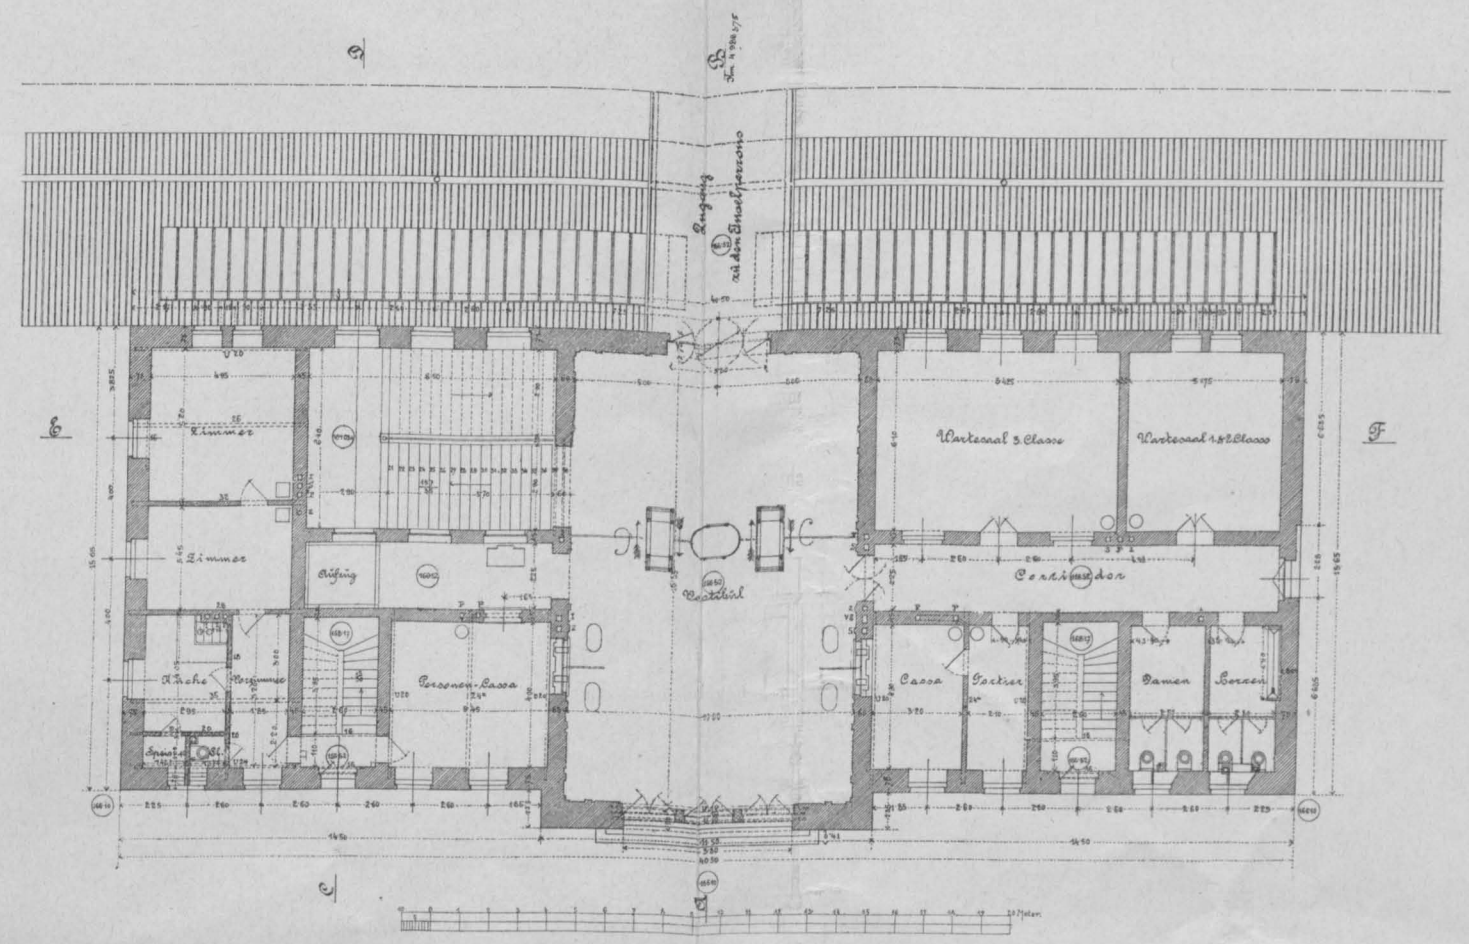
Grundriss des Aufnahmegebäudes in Straßenhöhe.
